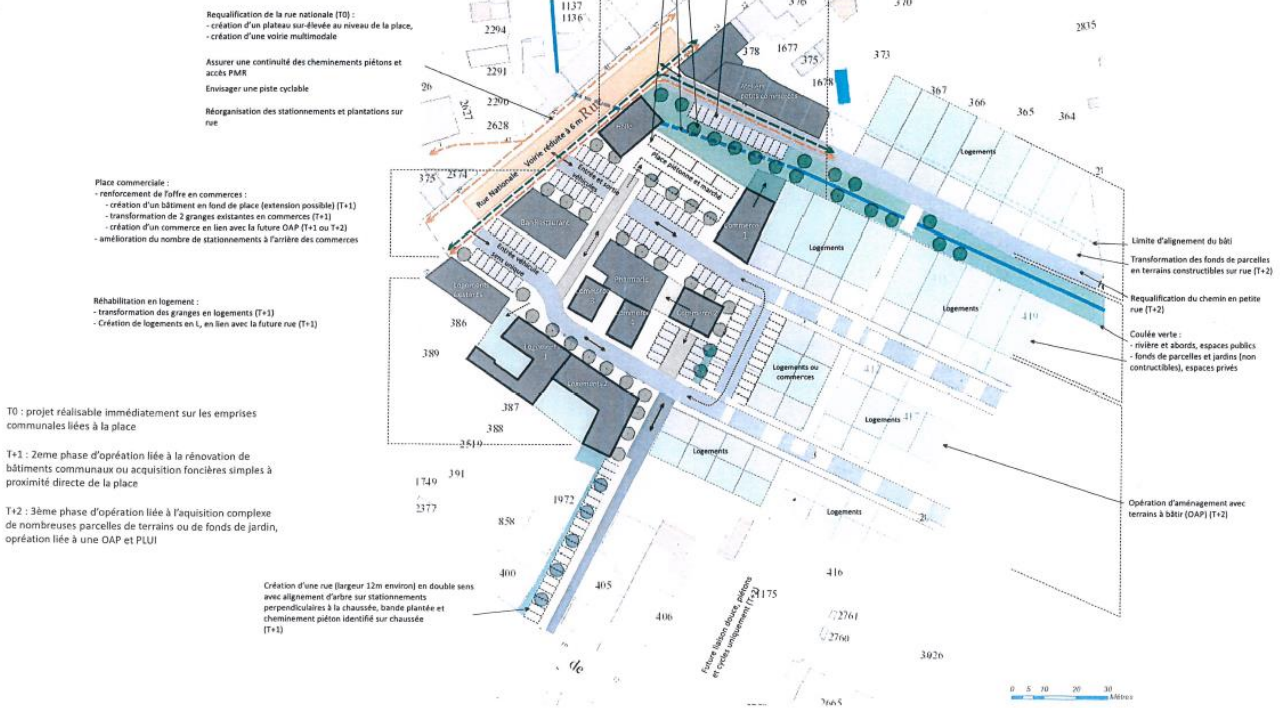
Etudes d'aménagement de la place Jean-Baptiste MOREAU (ADAC – Mars 2016)
